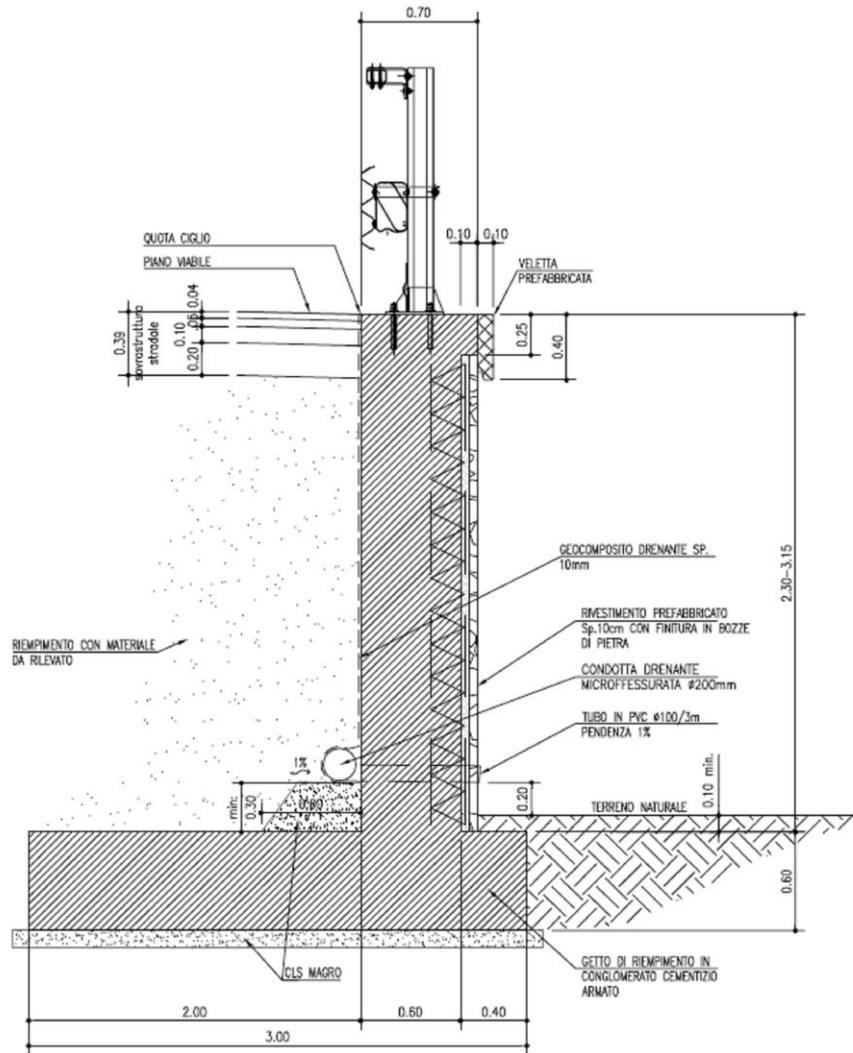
Sezione trasversale muro di sostegno in c.a. MS02
